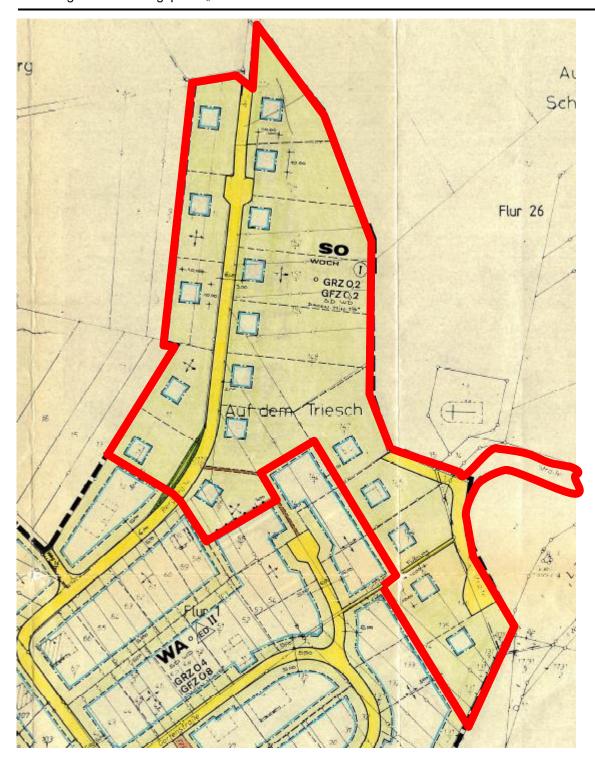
Rechtsgültiger Bebauungsplan "Auf dem Triesch"
